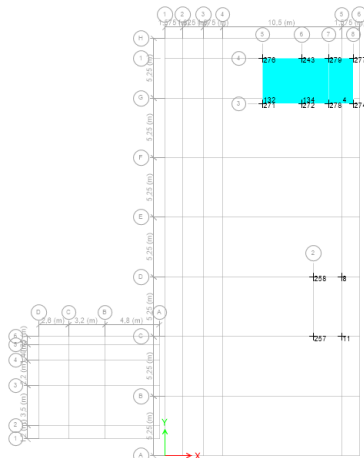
Layout Struktur pada Elev. +4,00 Gedung A
